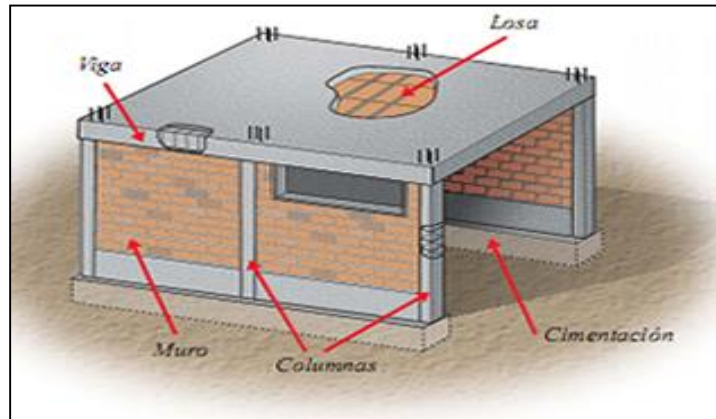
Ilustración de los elementos estructurales de albañilería confinada. Fuente: Aceros Arequipa (2016).
